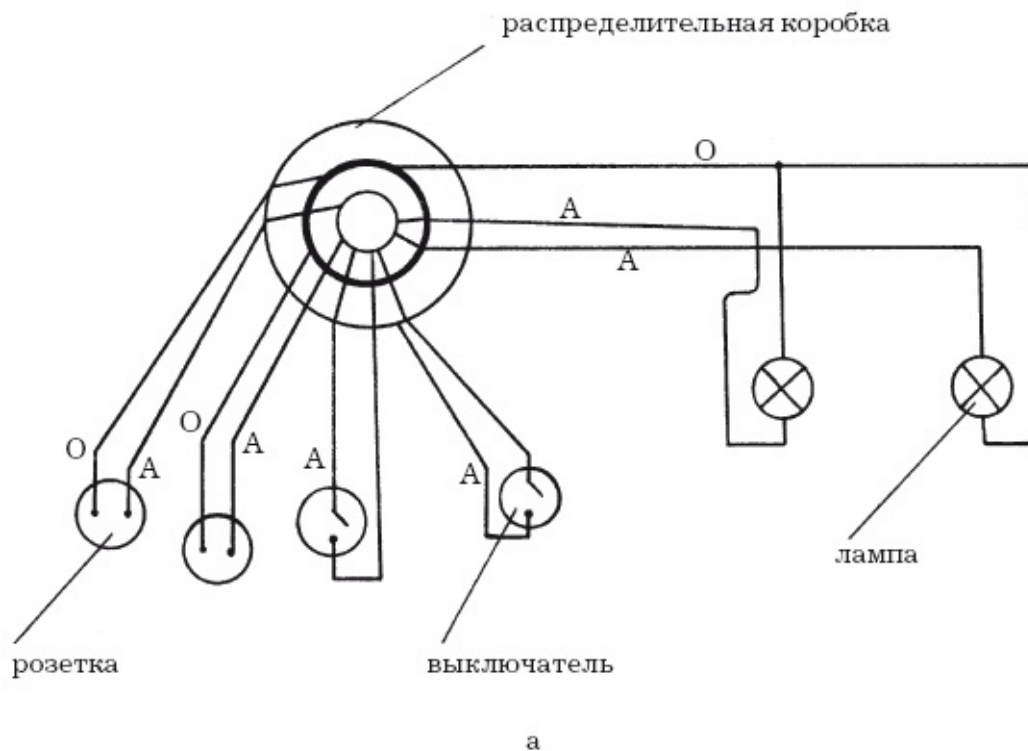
Принципиальная схема электроснабжения жилого дома: а – схема квартирной электропроводки
